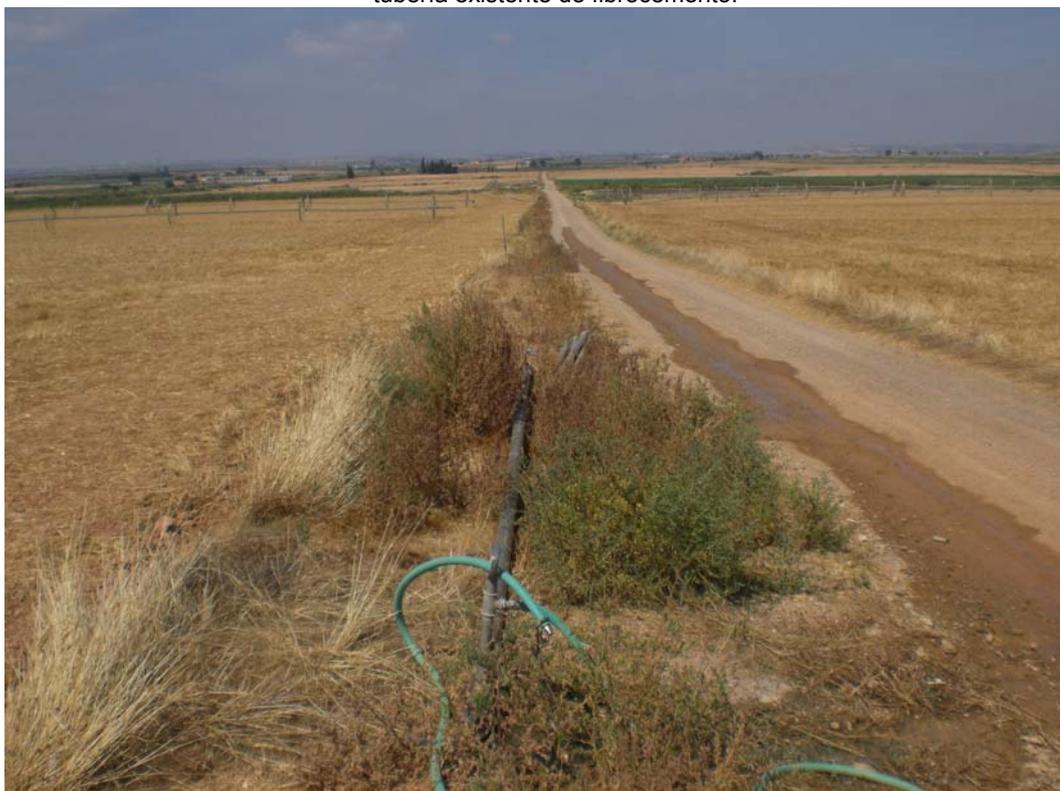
Uno de los hidrantes actualmente existentes en dicha tubería enterrada de fibrocemento.
